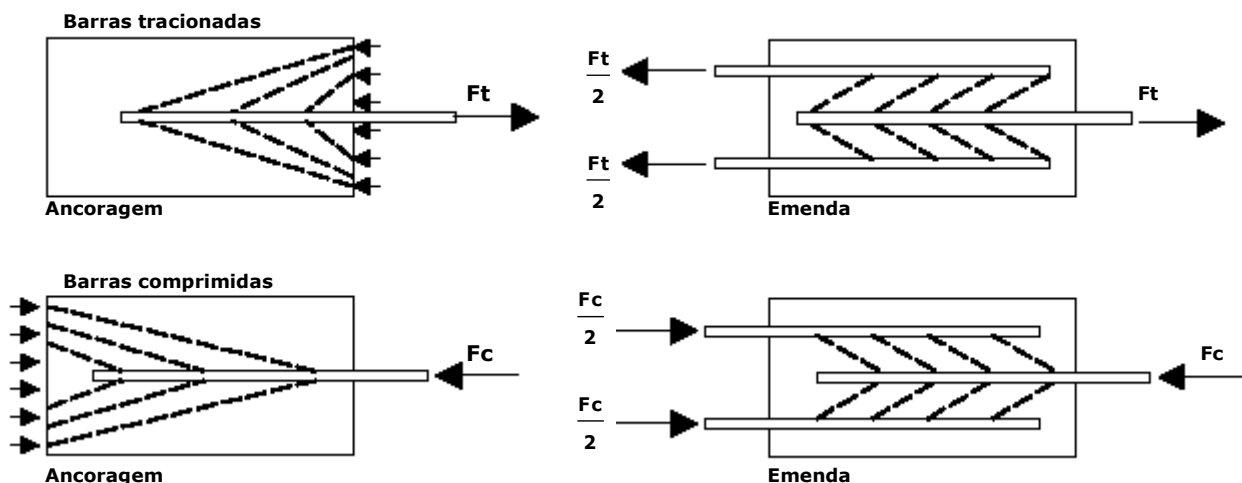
Esquema resistente nas ancoragens retas e emendas por traspasse
